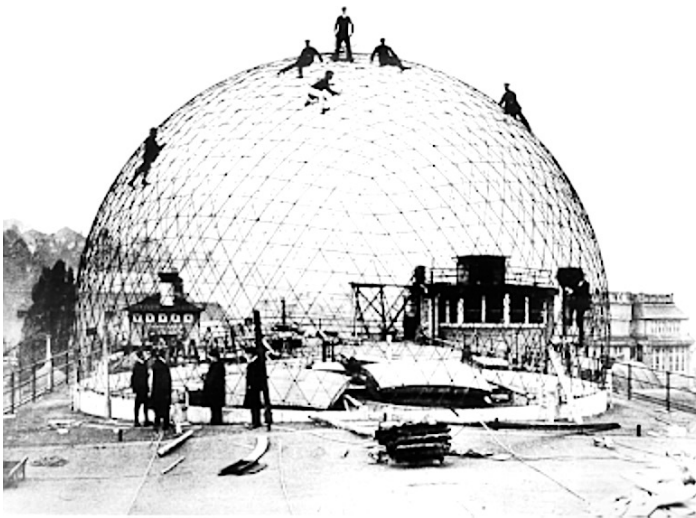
Primera "Thin concrete Shell" en Jena (Alemania)
